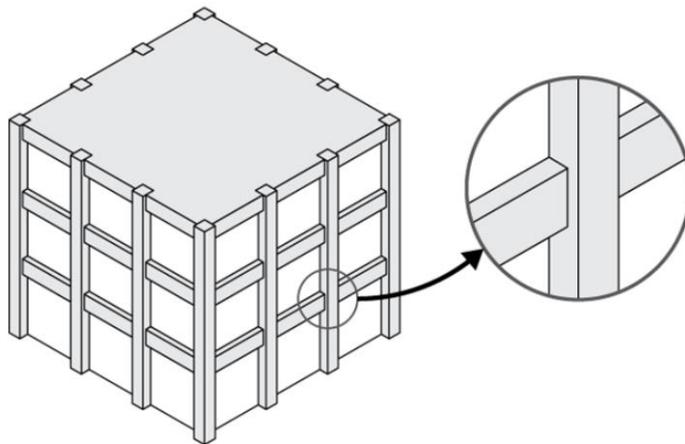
Esquema de edificio con vigas no alineadas a las columnas
